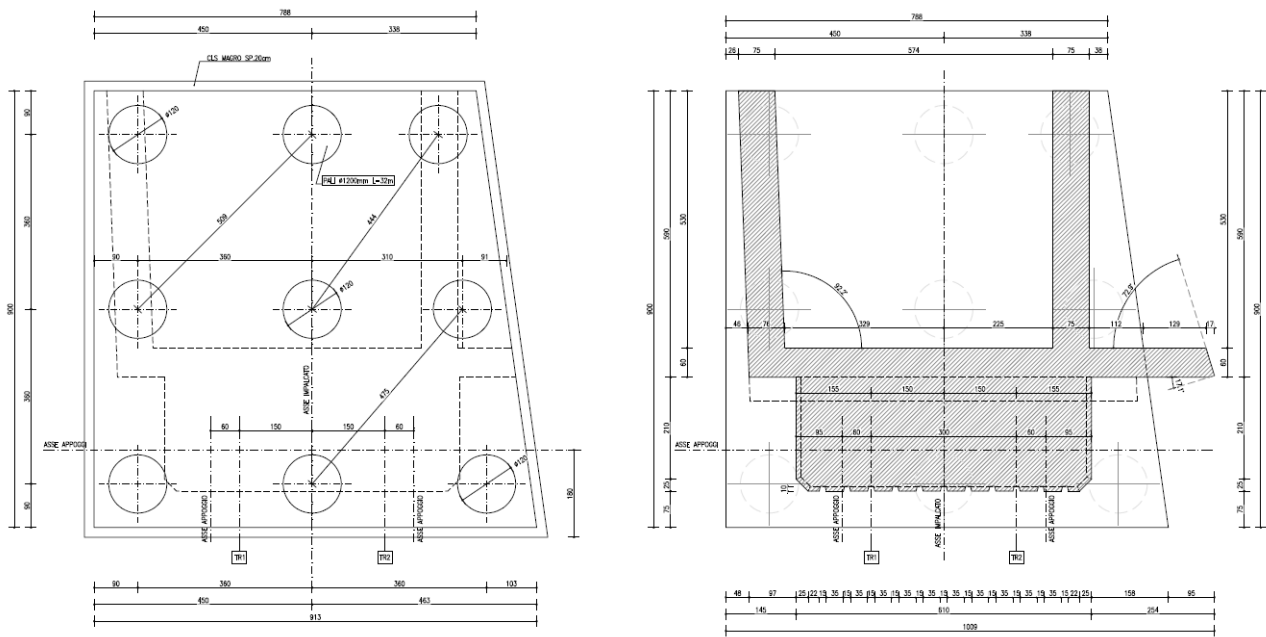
Spalla 1 – carpenteria fondazioni
